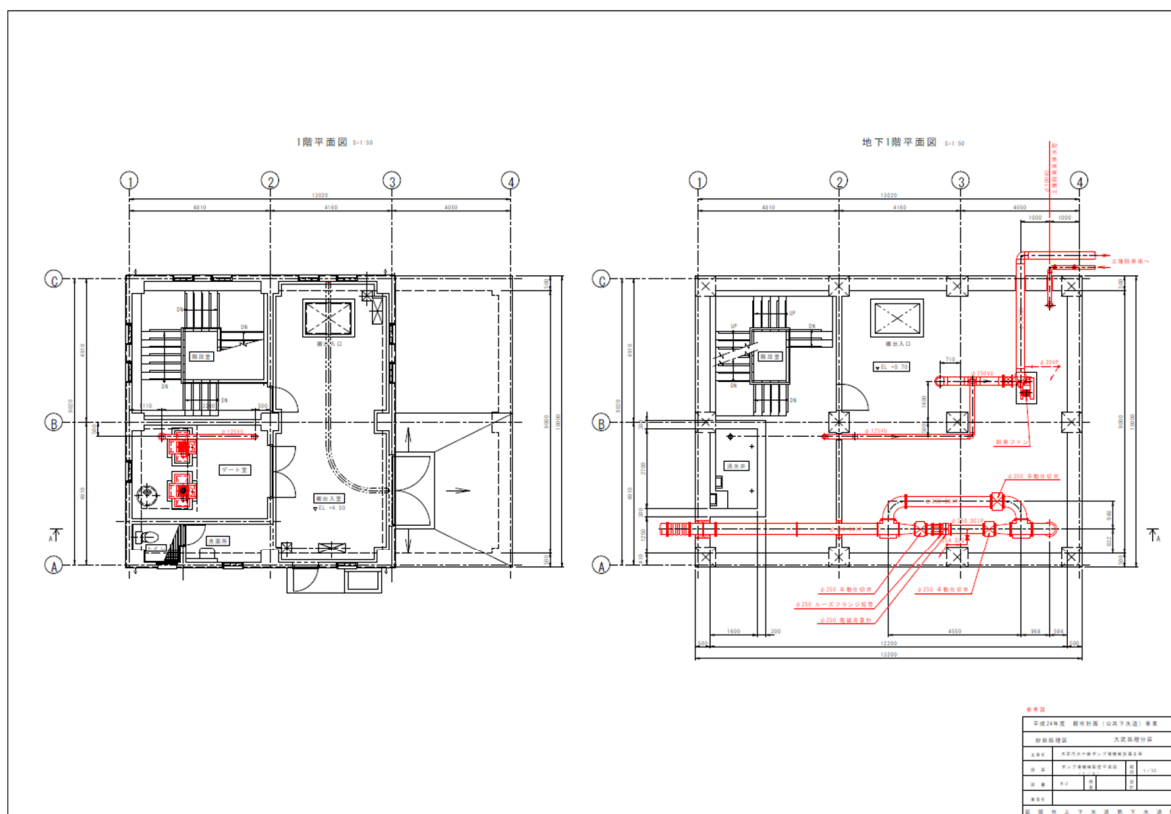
川原崎汚水中継ポンプ場の計画一般平面図
